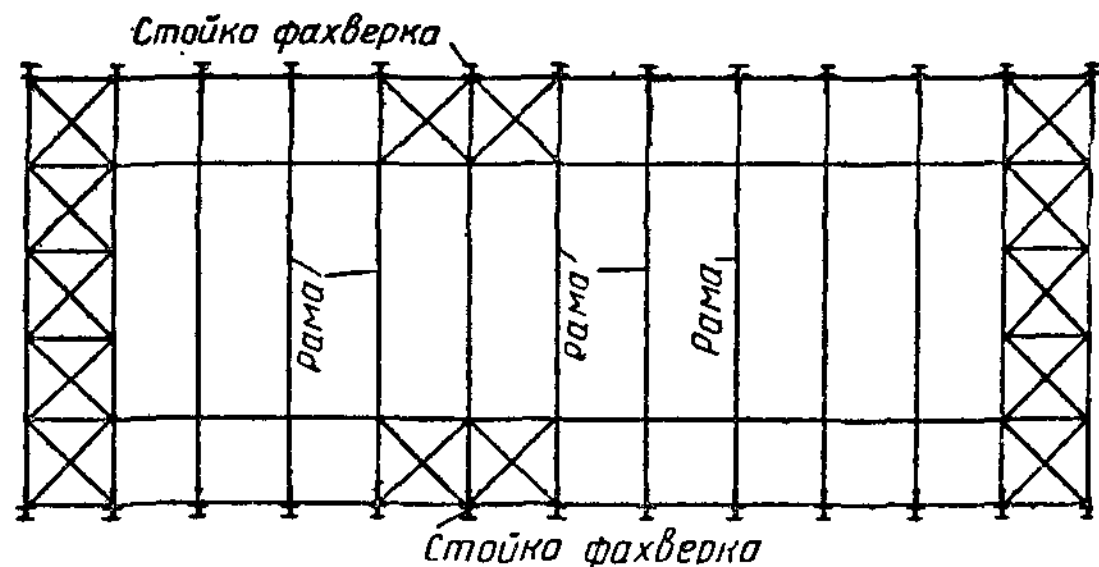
Передача горизонтальных нагрузок от стоек фахверка через продольные связи
